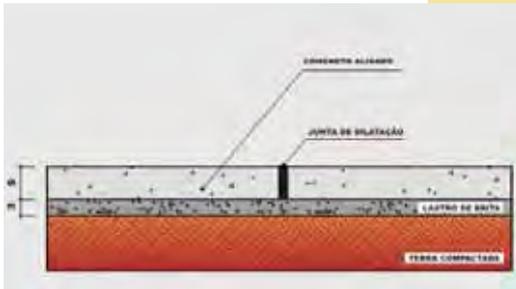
Modelo esquemático para aplicação de concreto alisado
